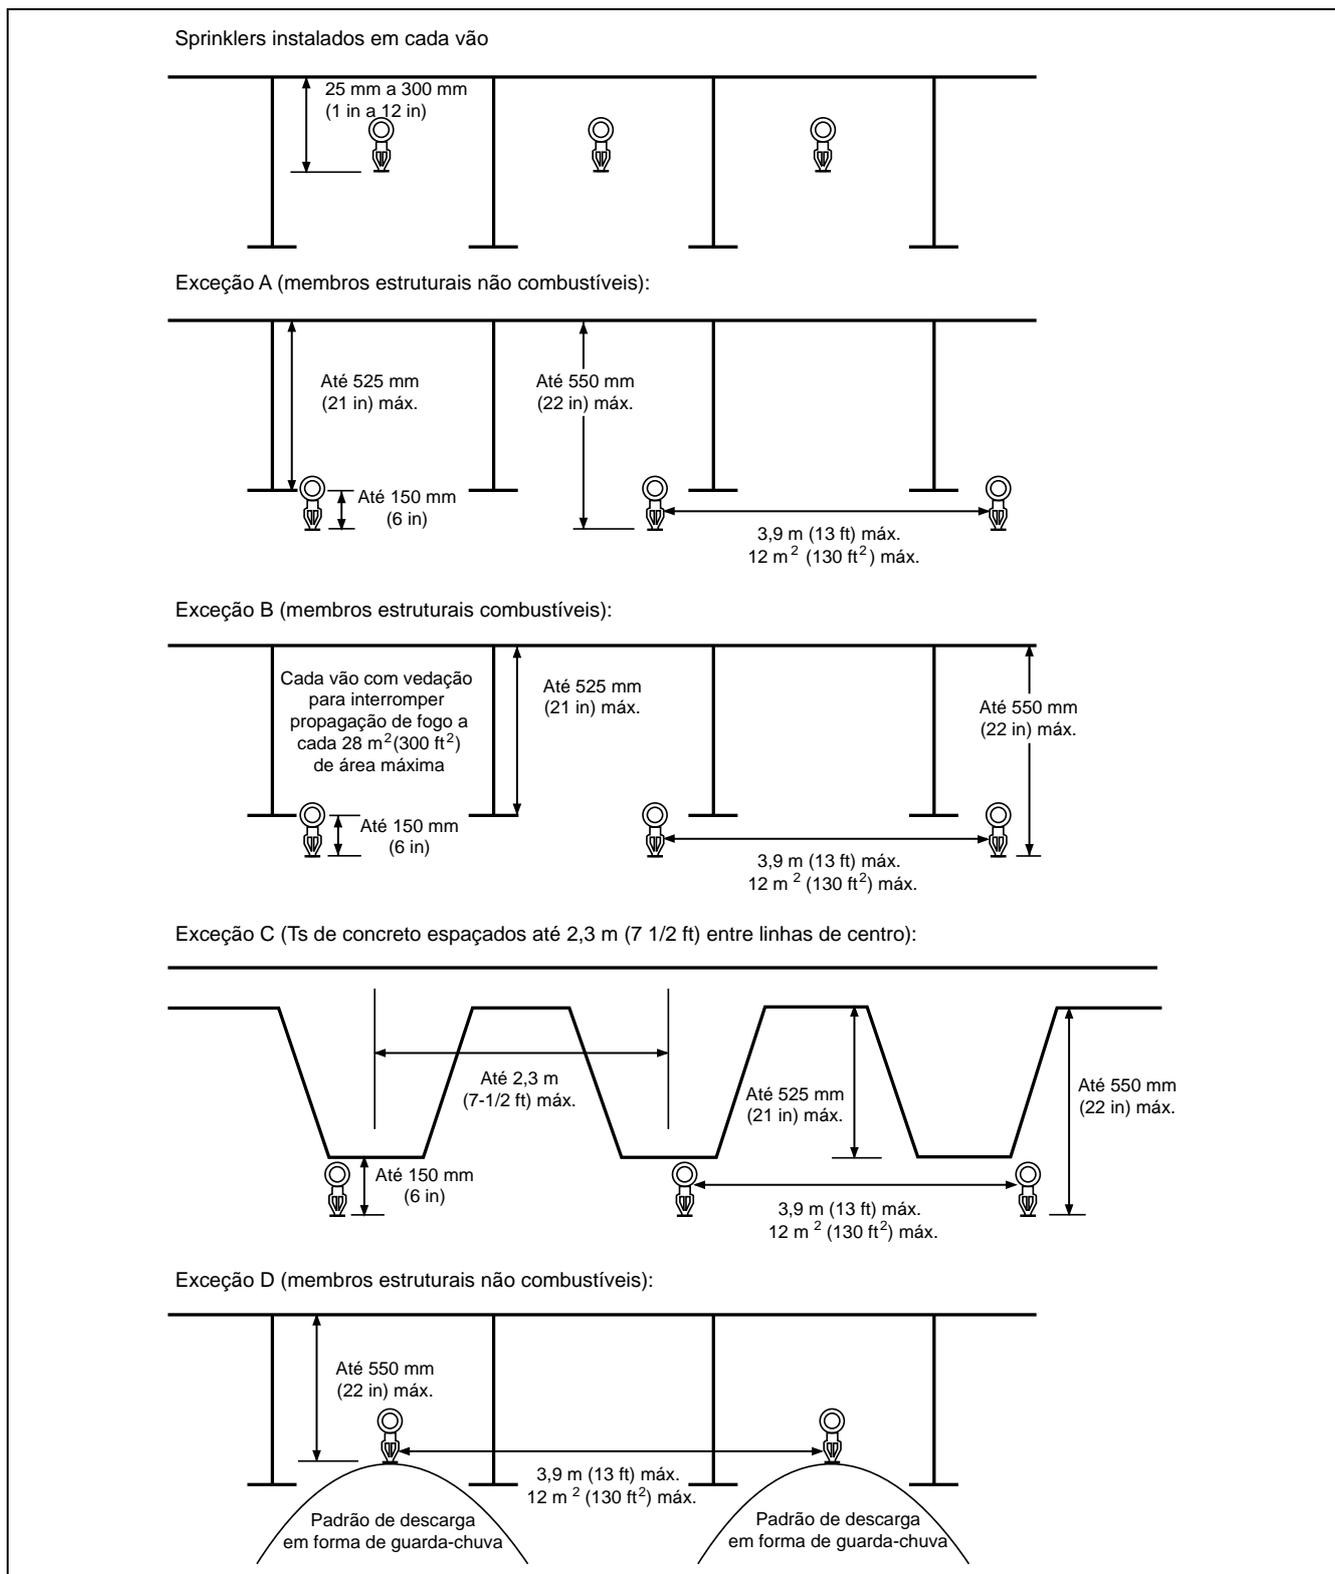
Localização de sprinklers para uso geral sob construção de teto obstruída.
